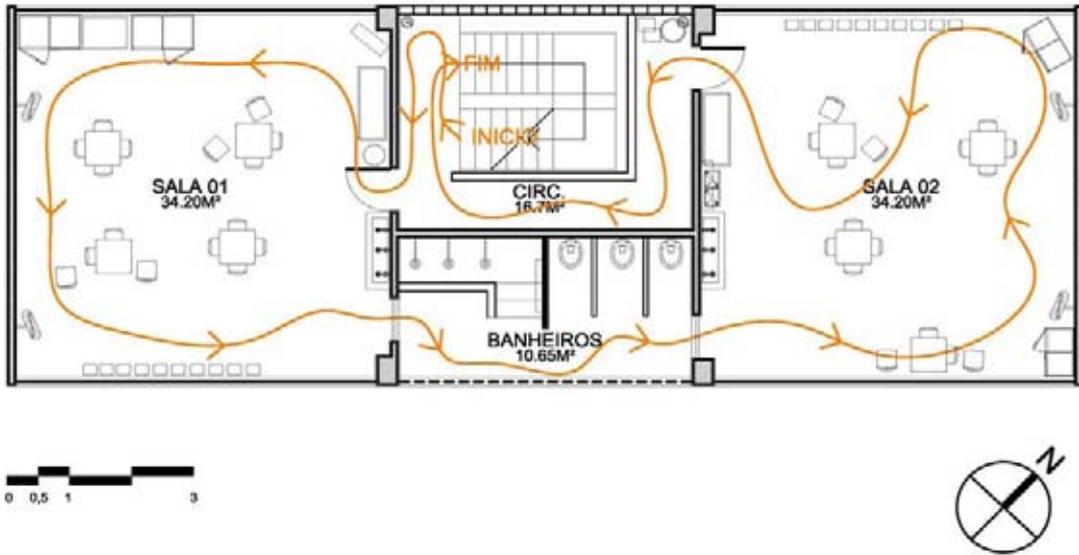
Percurso 2 – “Bloco 2”, 2º pavimento.
